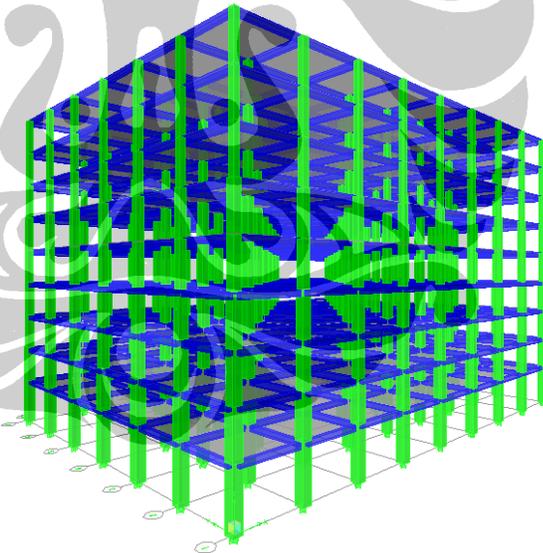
Model 3D gedung 7 lantai dengan ETABS
